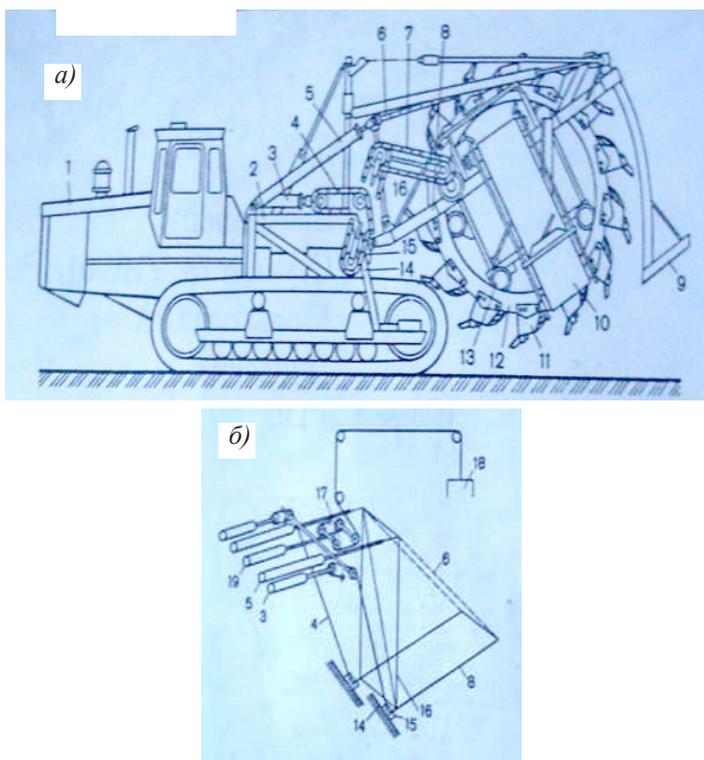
Экскаватор ЭТР-204А: а – общий вид; б – схема механизма подъема рабочего органа и откидной части конвейера; 1 – гусеничный тягач; 2 – рама; 3 – натяжитель; 4 – пластинчатые цепи; 5 – гидроцилиндр; 6 – цепи; 7 – привод; 8 – упор; 9 – зачистной башмак; 10 – рама рабочего органа; 11 – ковши; 12 – ротор; 13 – пара роликов; 14 – упор; 15 – скоба; 16 – тяга; 17 – полиснаст; 18 – механизм подъема; 19 – цилиндр
